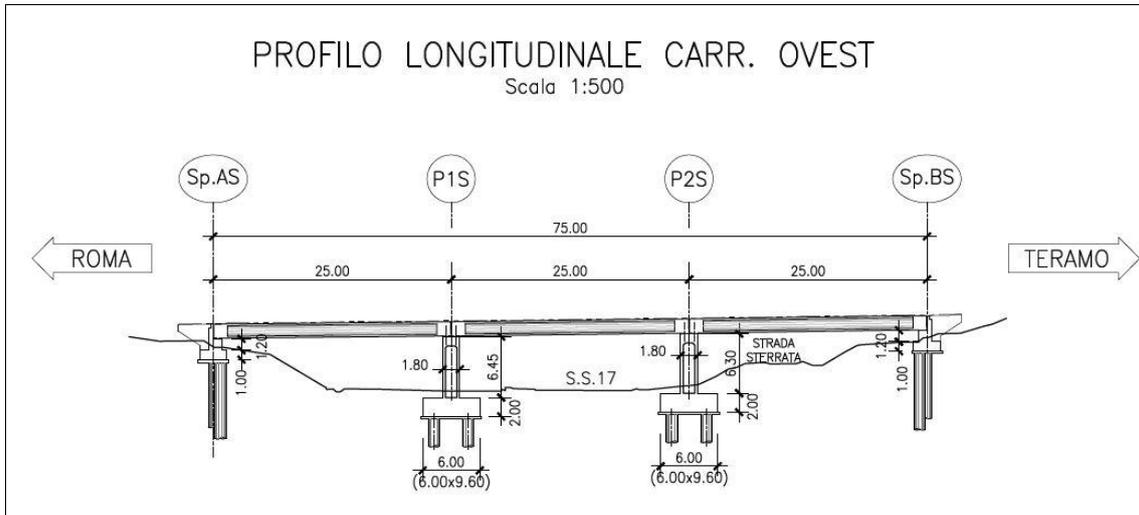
Prospetto viadotto SS17 – Stato attuale
